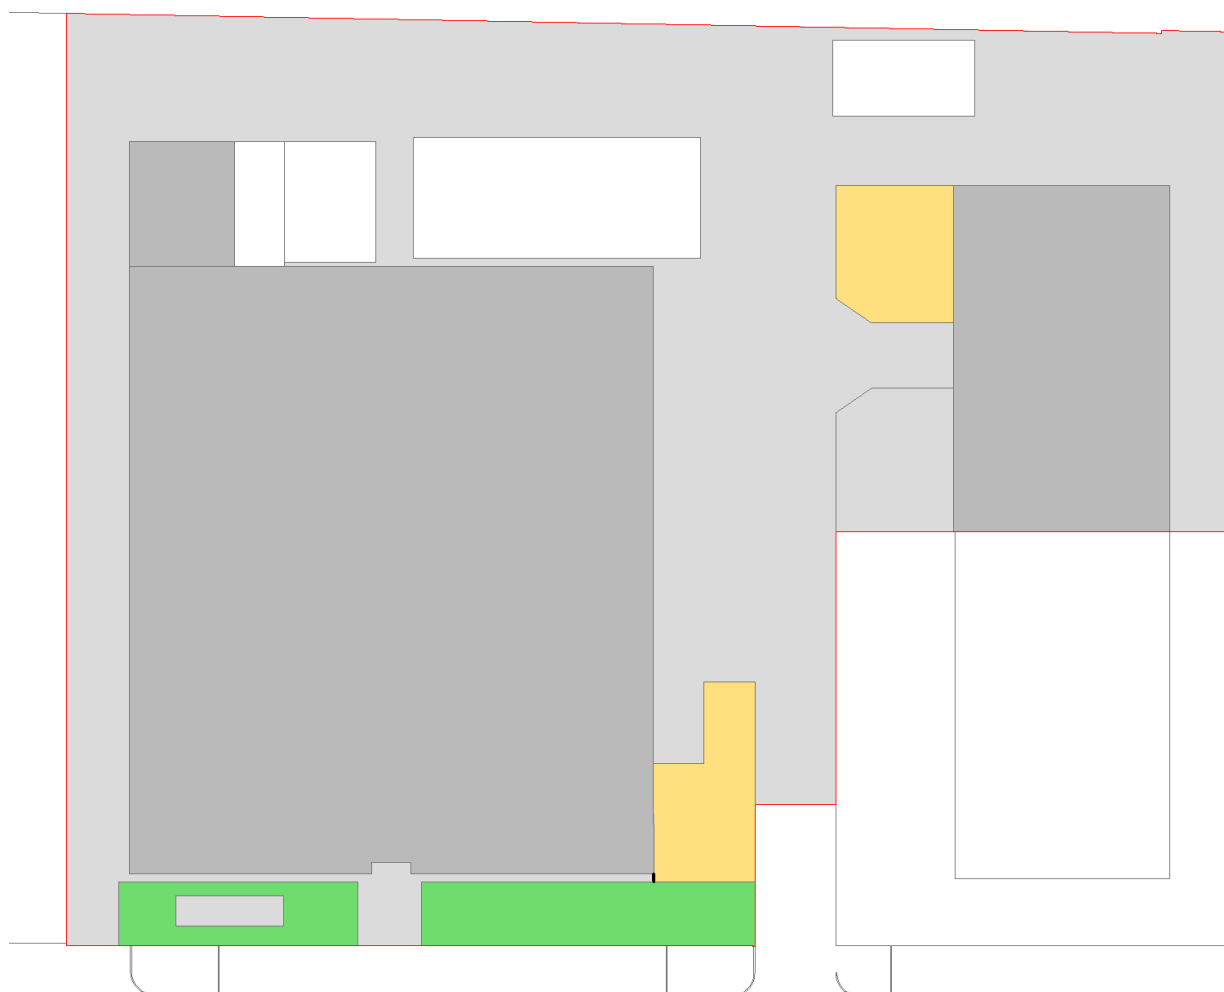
Planimetria stato di progetto – Layout generale del nuovo impianto
